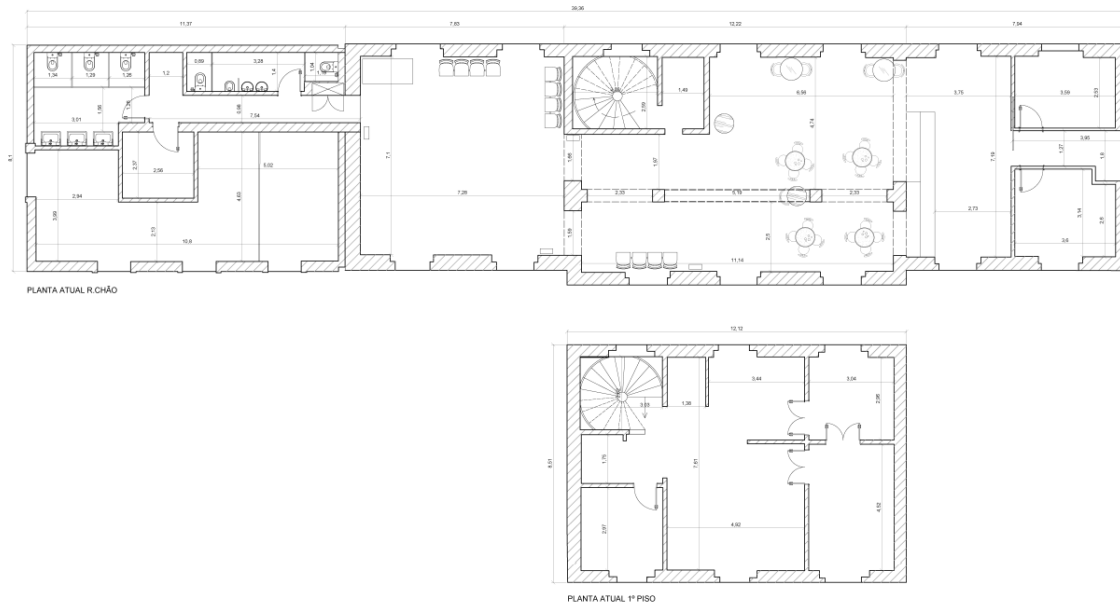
Planta de Levantamento cotada, Piso 0 e Piso 1
